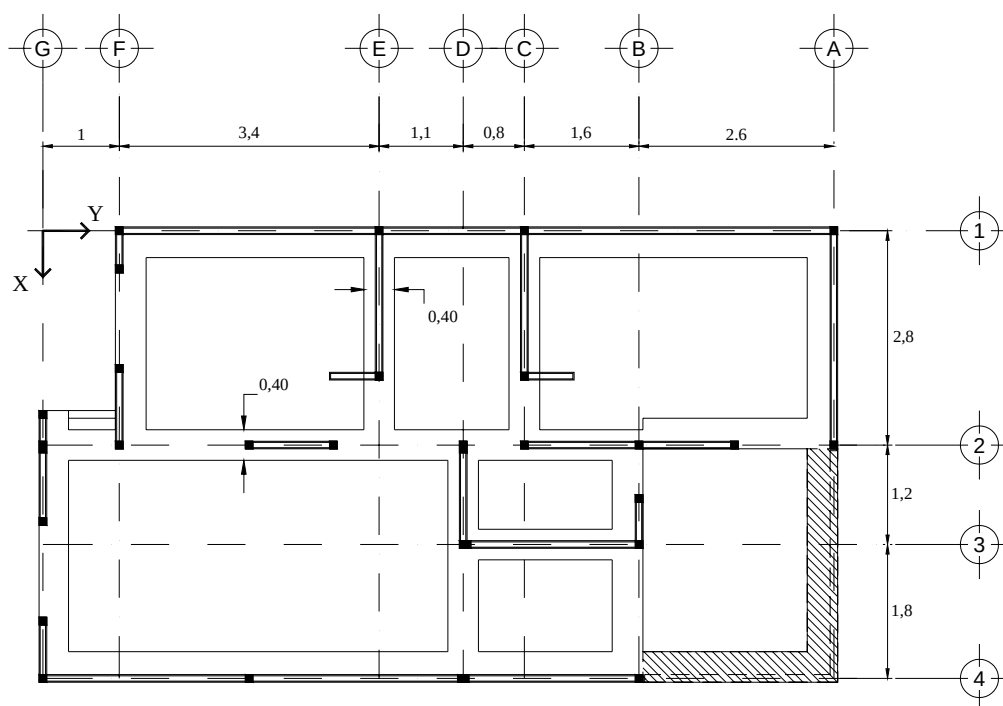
Planta de cimentación y de muros (dimensiones en m)
